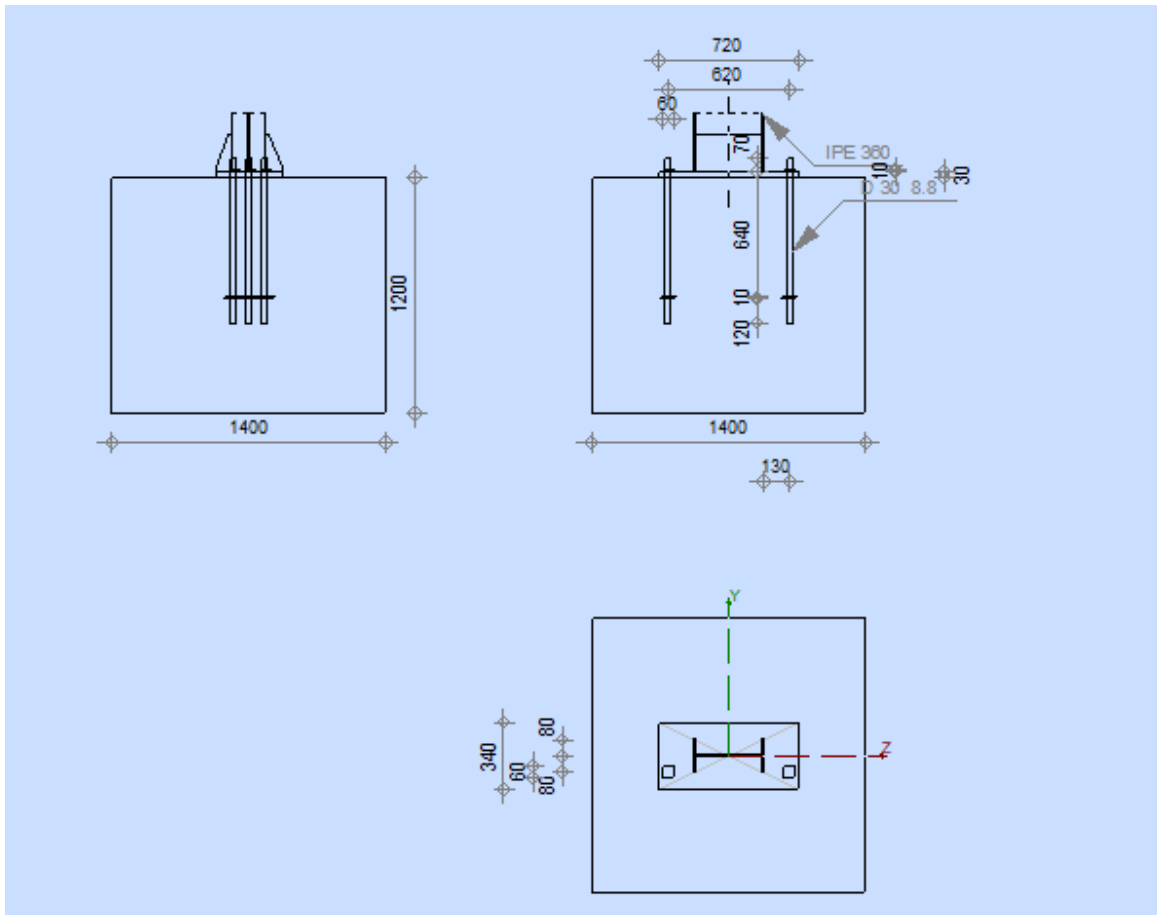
Dessin des coupes de la jonction poteau-fondation.
